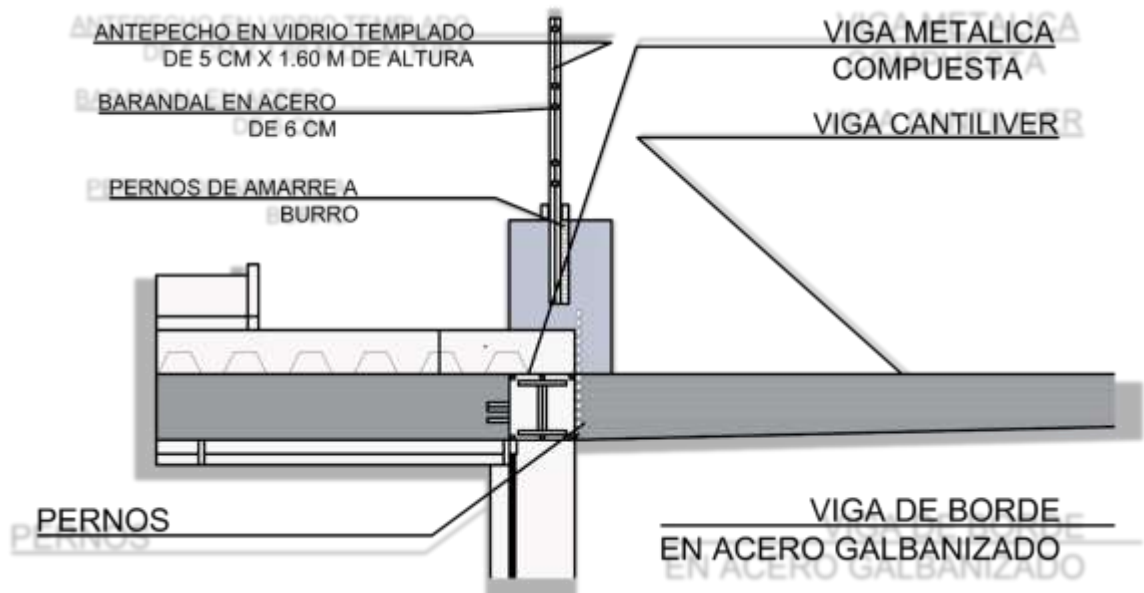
Detalle Estructura de Recubrimiento Orgánica
